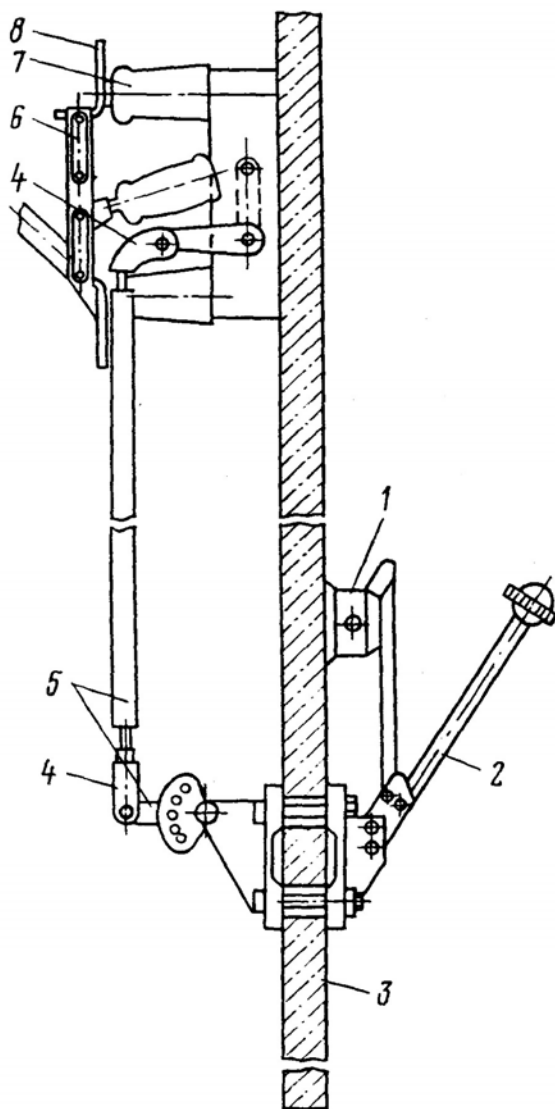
Общий вид установки разъединителя: 1 – блок вспомогательных контактов; 2 – рукоятка; 3 – стена; 4 – вилка; 5 – тяги; 6 – нож; 7 – разъединитель; 8 – неподвижные контакты
